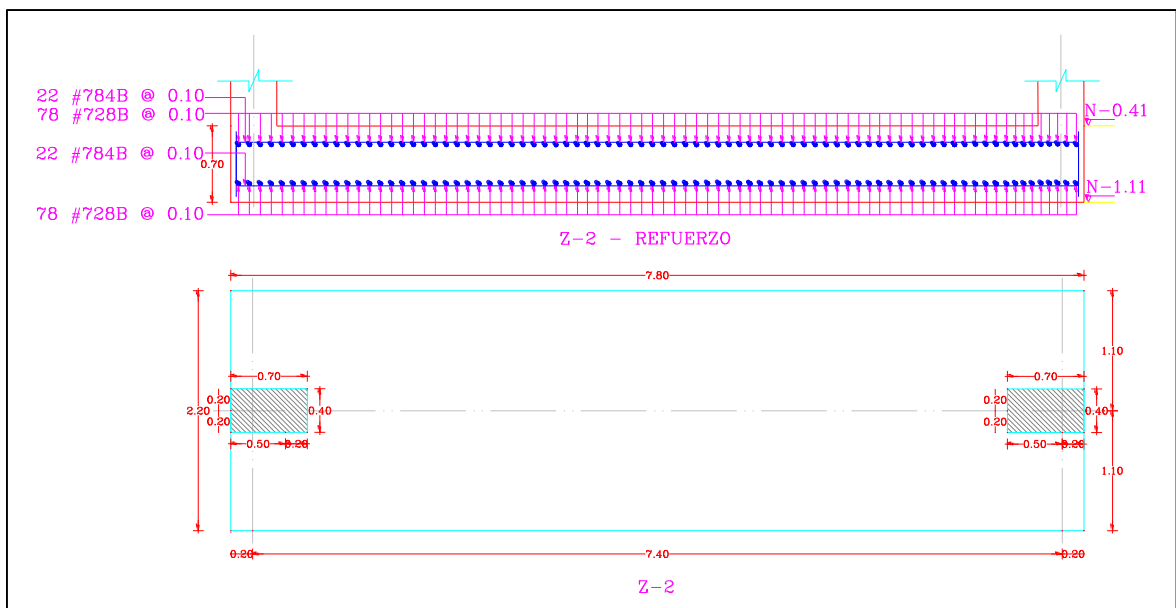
Detalle de refuerzo zapata Z-2.
